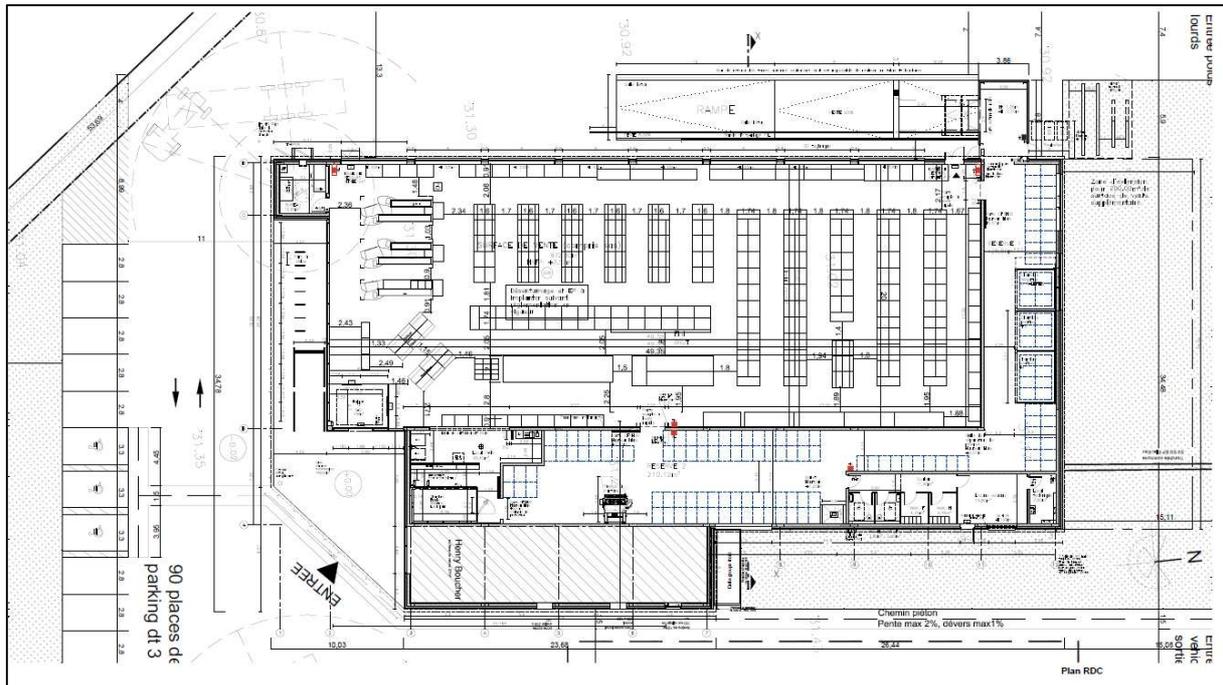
Plan projet du bâtiment (source : IMMALDI)
